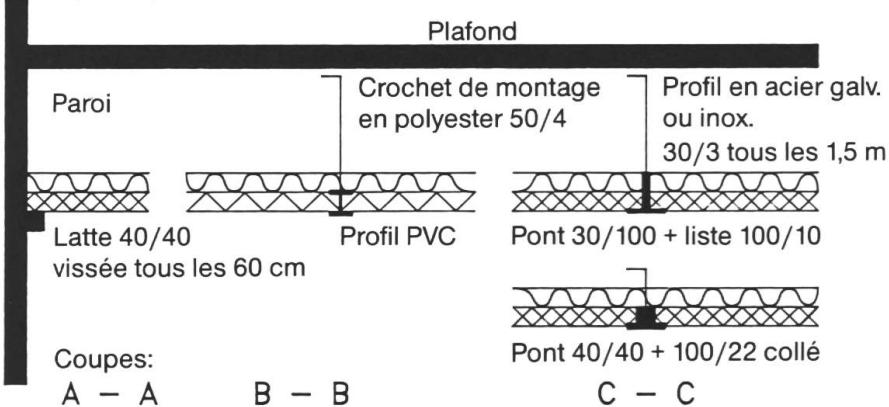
Suspension des plafonds ventilés avec des profils en bois en T sous le plafond existant en bois ou en béton.
